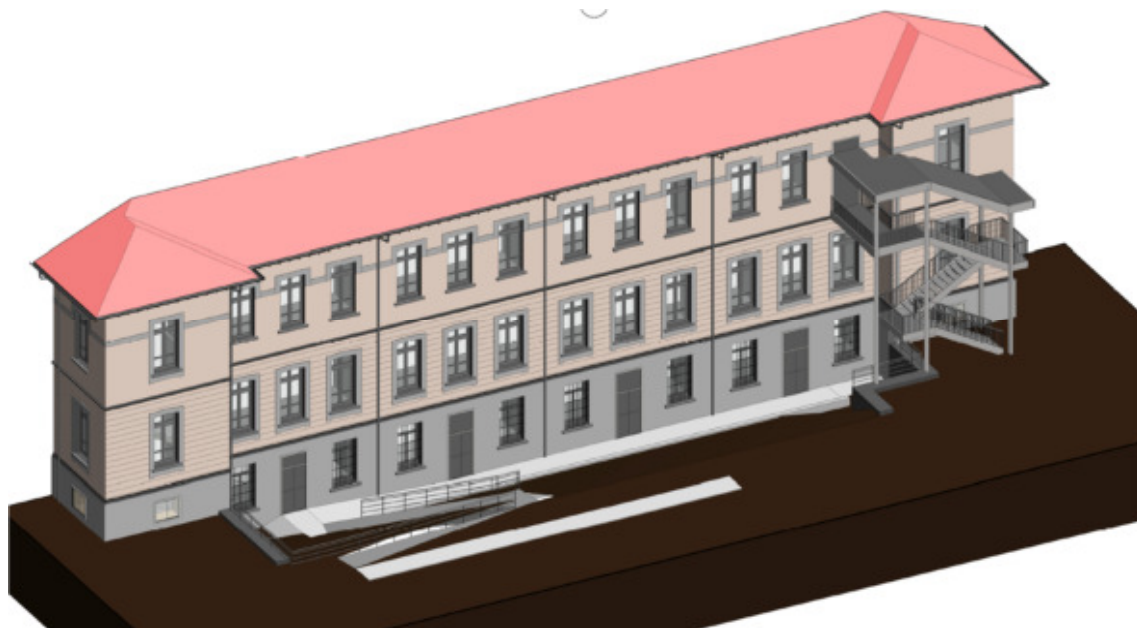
Vista degli accessi sul retro allo stato di progetto
